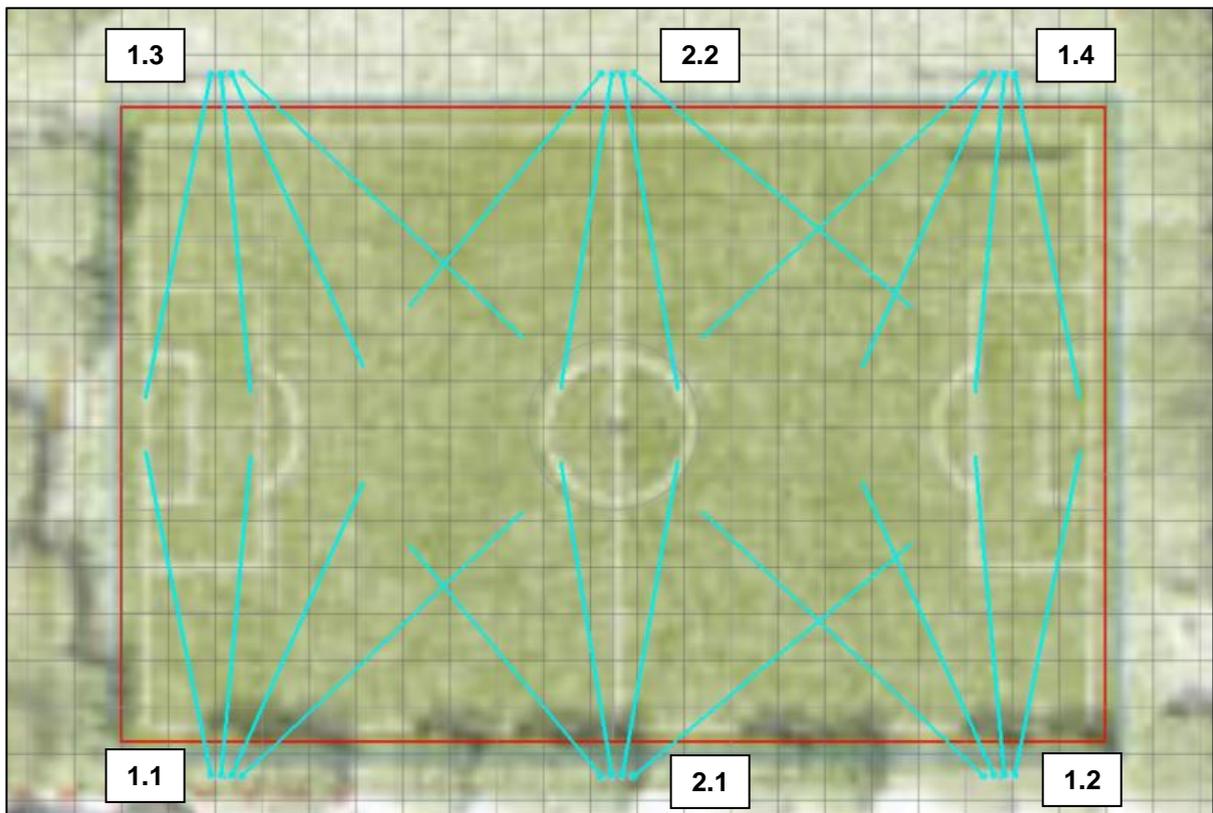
Anordnung der Leuchten des neuen Kunstrasenplatzes mit Bezeichnungen
